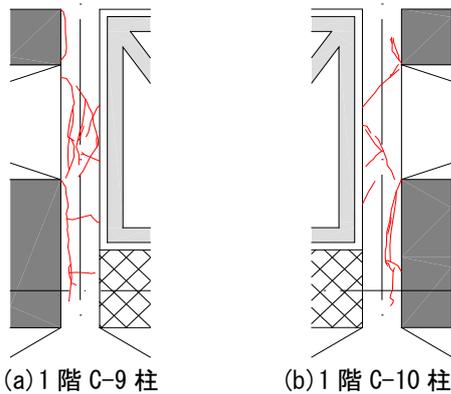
鉄骨ブレース脇の柱ひび割れ図
